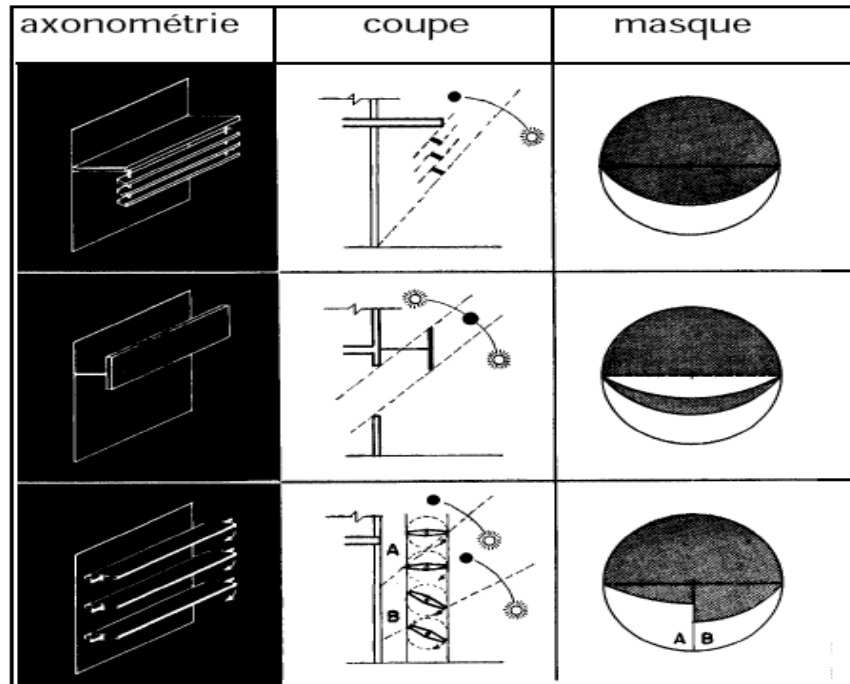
Exemples de brises soleil type horizontale (source : Olgyay,1963)
